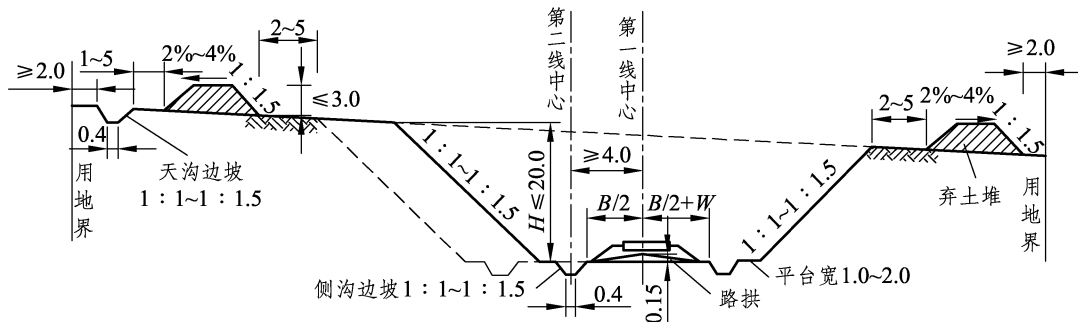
曲线地段一般黏性土路堑典型横断面图 (单位: m)
